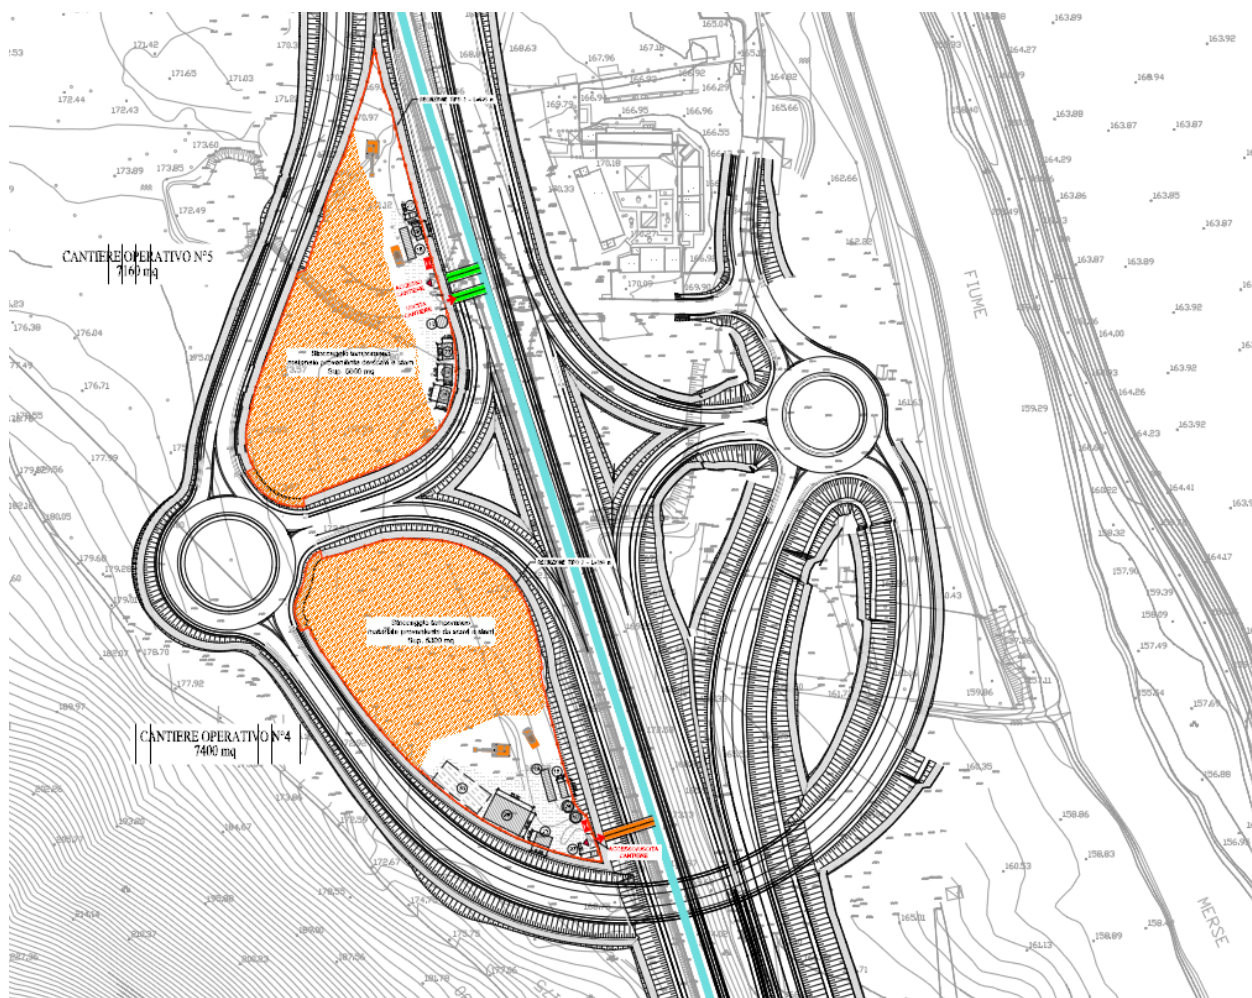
Planimetria cantiere operativo 4 e cantiere operativo 5.
